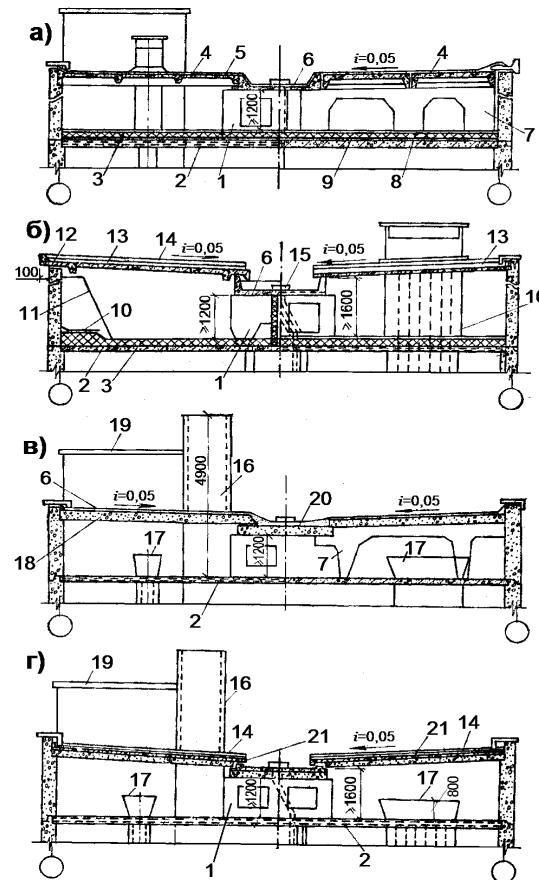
Принципиальные схемы конструкций чердачных железобетонных крыш.
